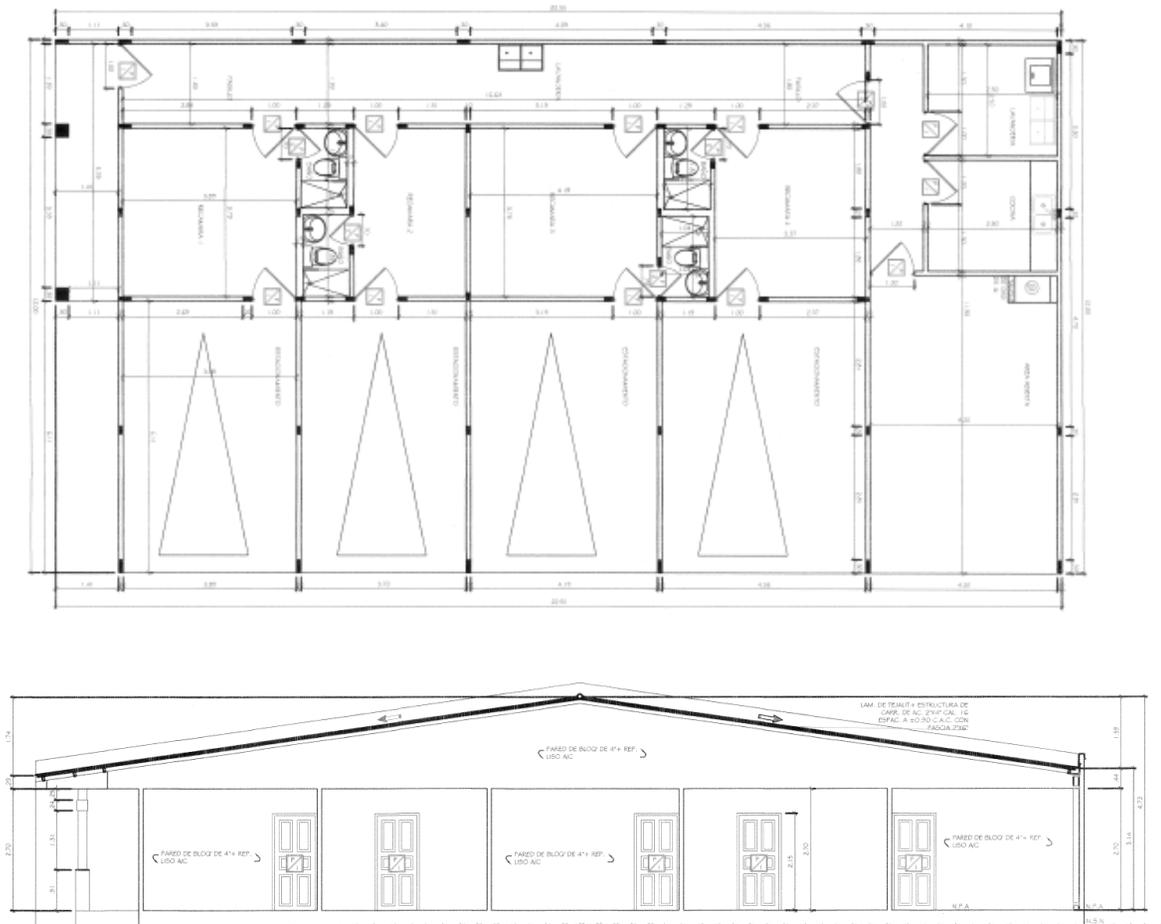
Planta arquitectónica y planta frontal de la edificación (fuente: plano)
